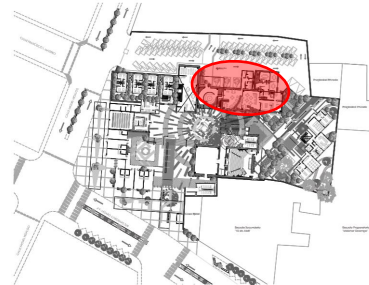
Planta arquitectónica de Restaurante, Centro multidisciplinario Ex hacienda Cusi.
